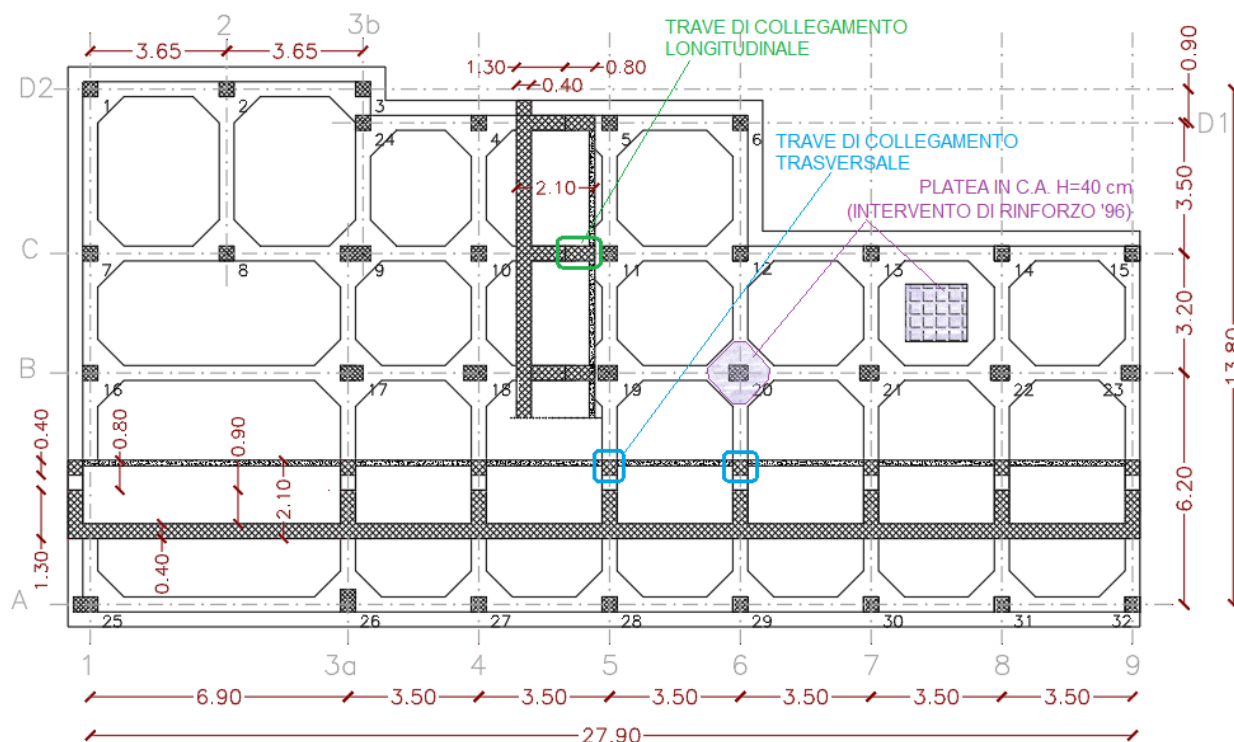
STATO DI FATTO: STRALCIO DELLA PIANTA DI FONDAZIONE DEL BLOCCO A
